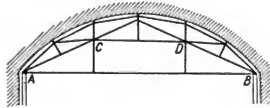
Lehrgerüst mit Trapez- und Dreiecksprengwerken.
